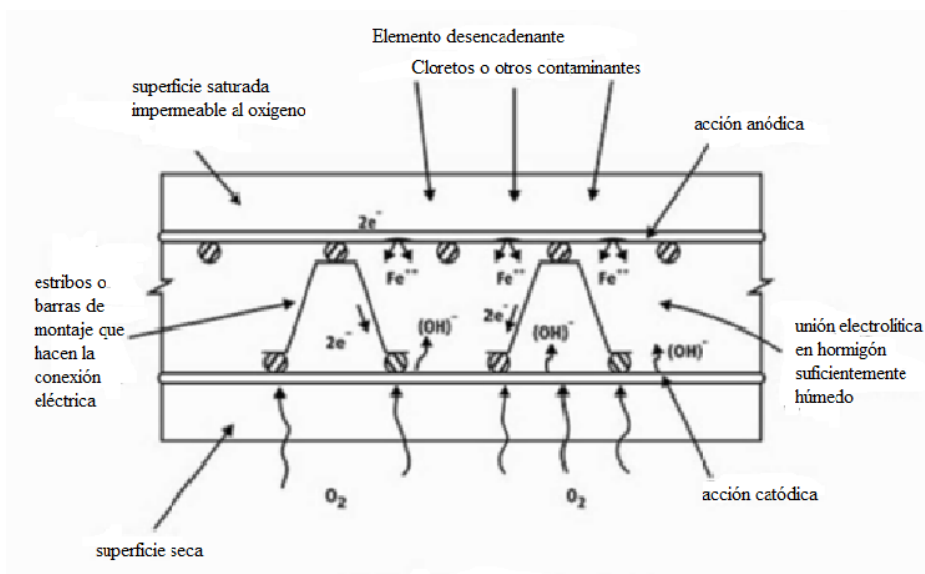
Corrosão na armadura do concreto por macro pilha. Fusco (2008).
